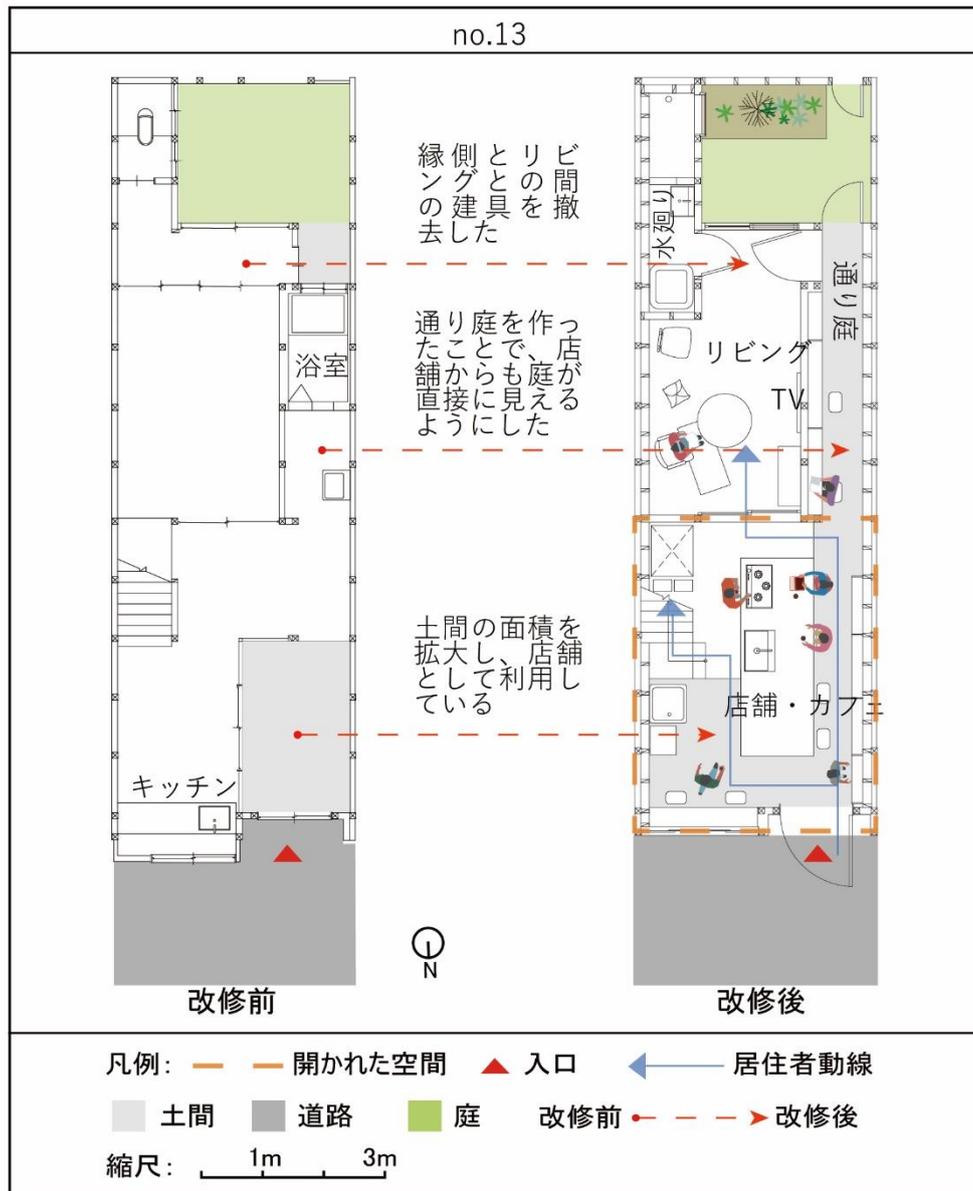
事例 no. 13 の改修前後の平面配置図
